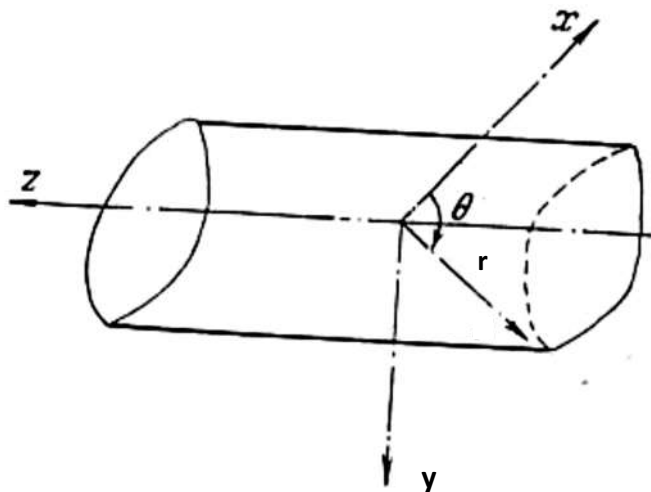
Esquema de una excavación en un sistema de coordenadas cilíndricas.
